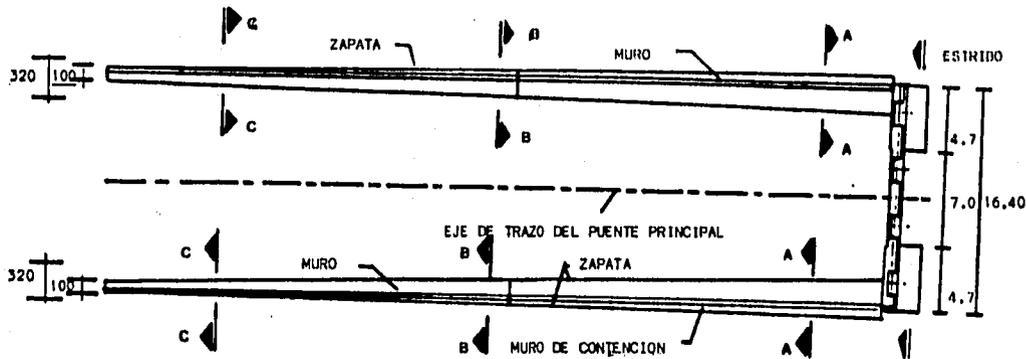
PLANTA DE RAMPA DE ACCESO
